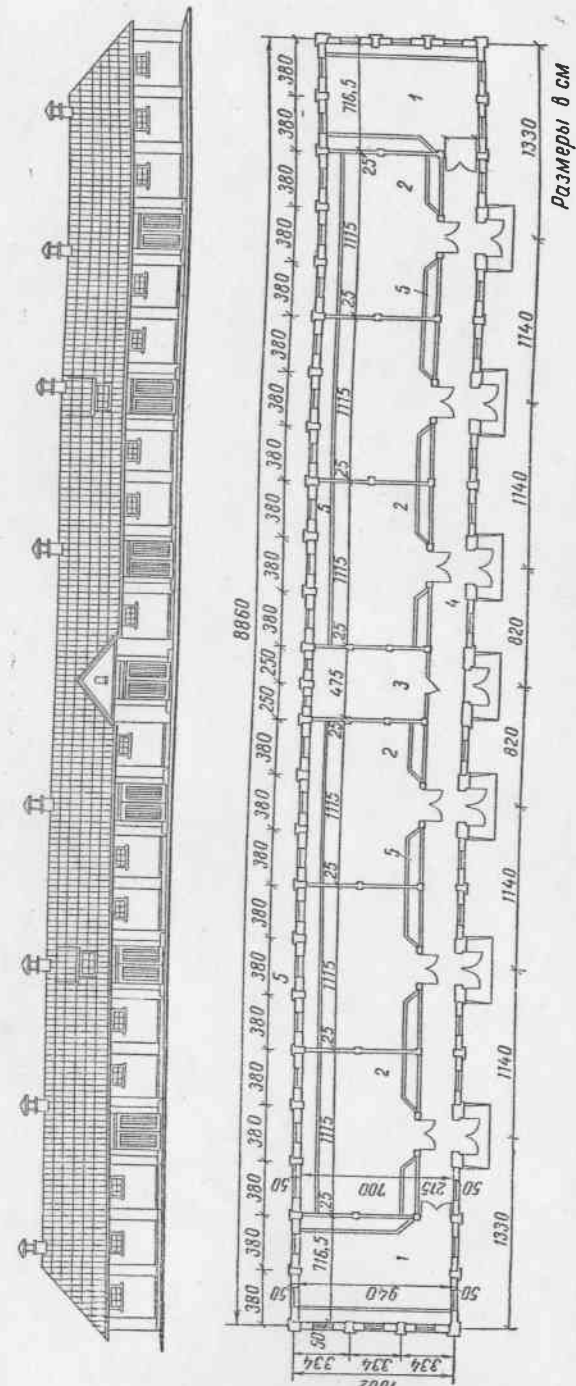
Конюшня на 100 племенных жеребят табунного содержания (фасад и план): 1—денники на 11 голов площадью по 67,50 м²; 2—денники на 13 голов площадью по 78,05 м²; 3—фуражная площадью 33,25 м²; 4—проход площадью 157,33 м²; 5—кормушки.
